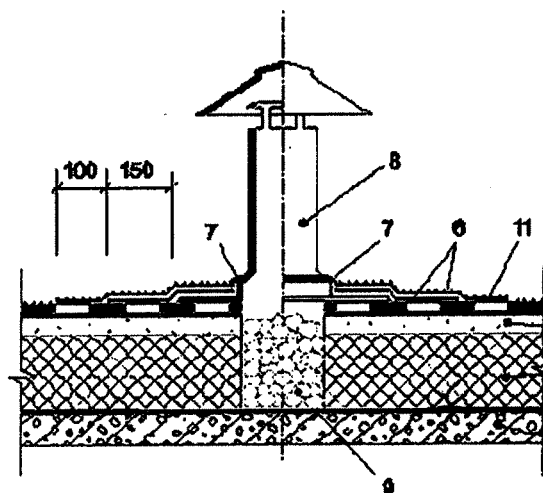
Схема устройства вентиляционного патрубка на плоской крыше:
